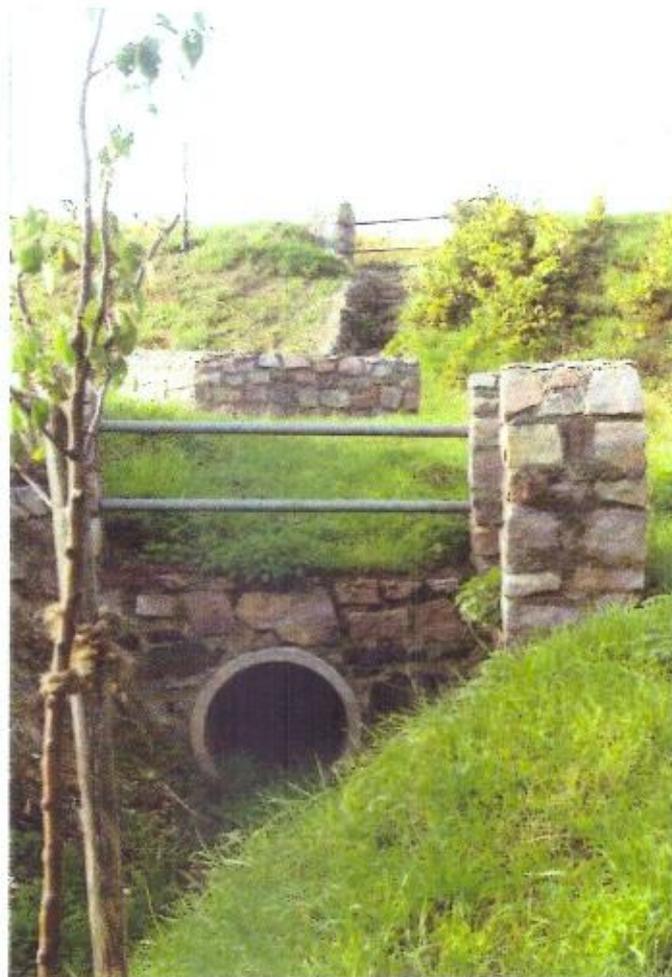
Untere Stufe eines Knotenpunktes der Wasserführung
